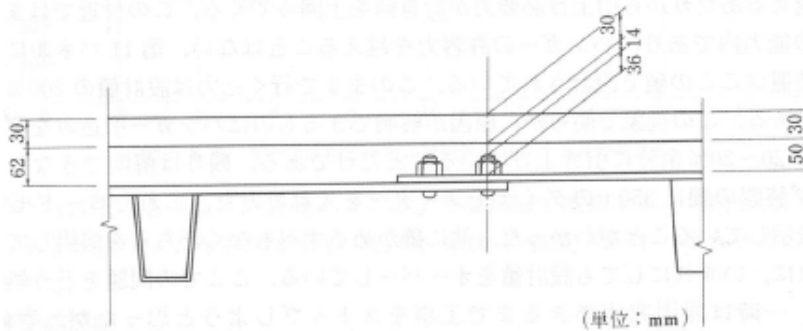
床版横断方向継手部の舗装断面 (単位: mm)
